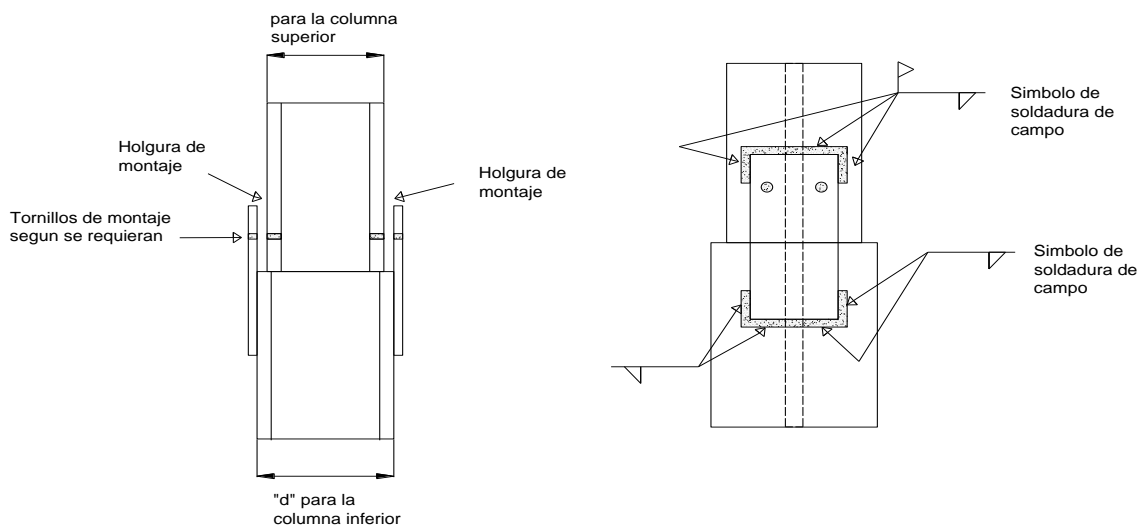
Vista en elevación de empalmes de columnas de igual peralte.
